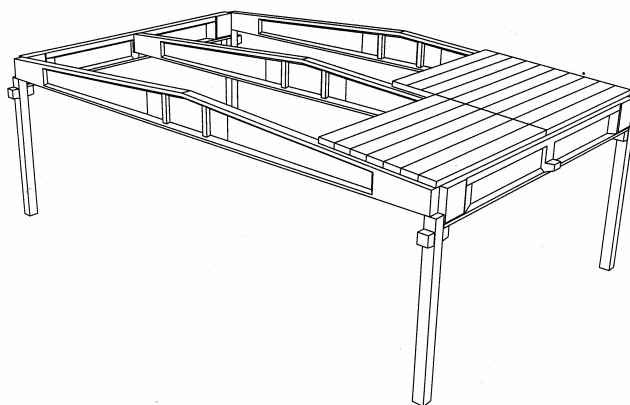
Estrutura com traves aporticadas com vigas de cobertura principais e vigas primárias de fechamento.
